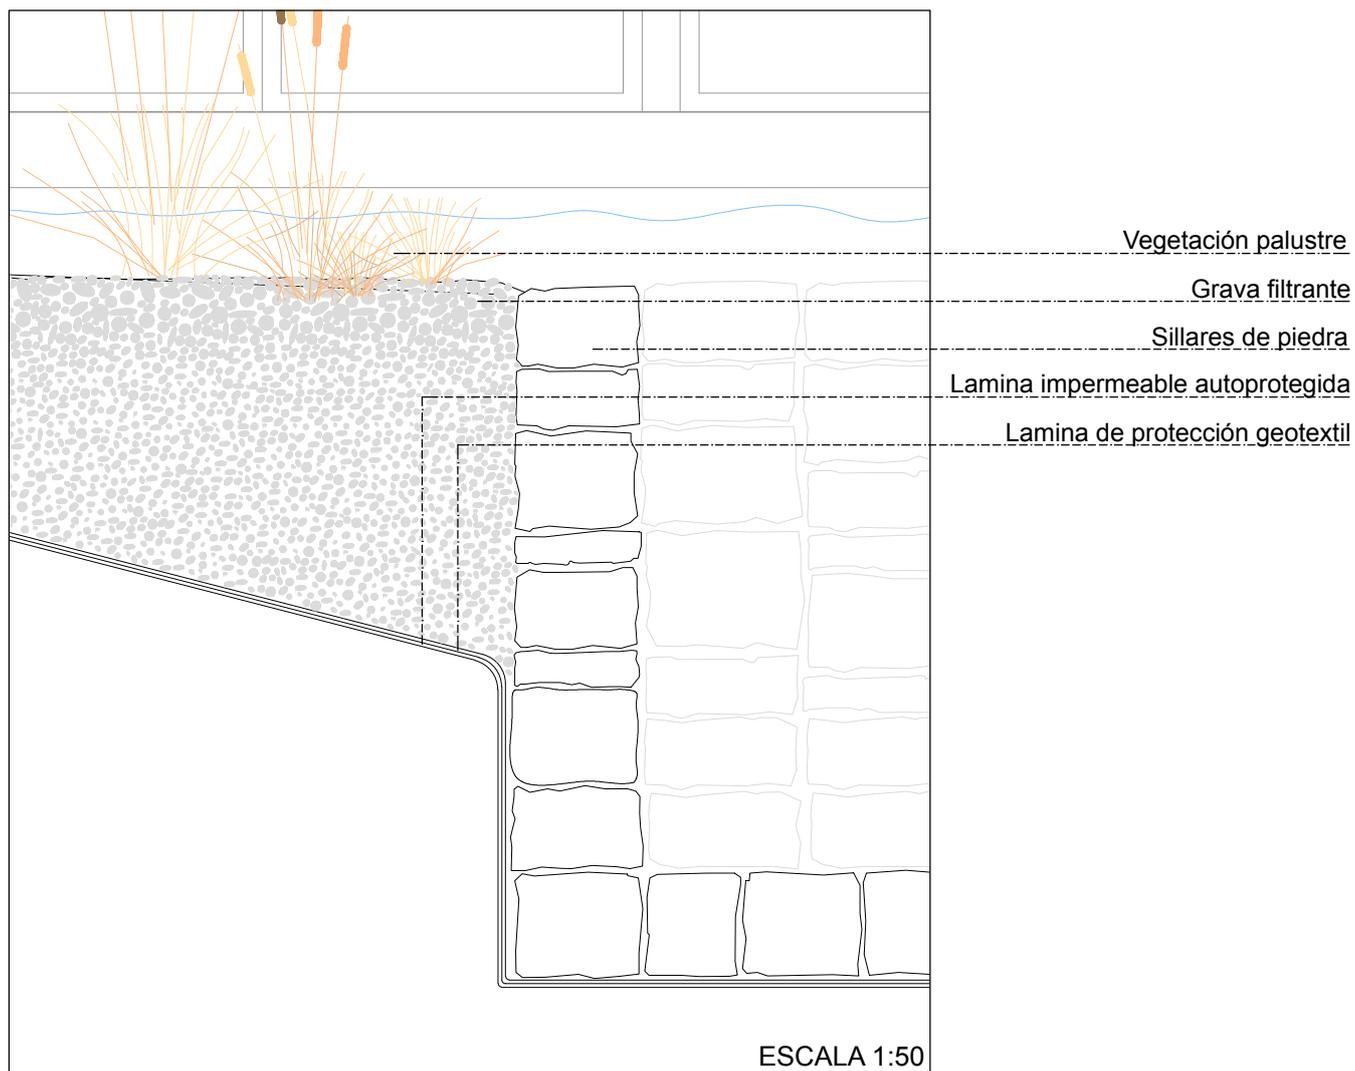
Detalle constructivo: piscina. 2018. Fuente propia.
